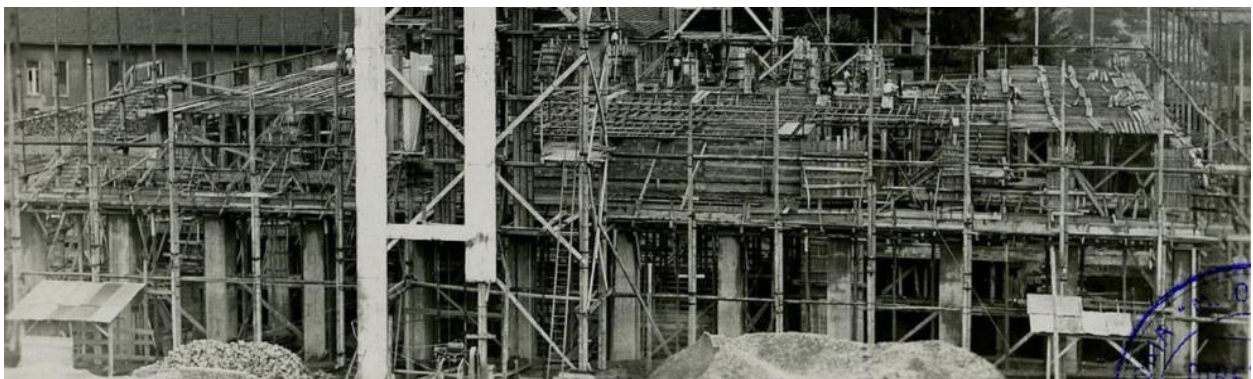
Dettaglio di una foto di cantiere con i pilastri in fase di esecuzione (ACSR 72)
